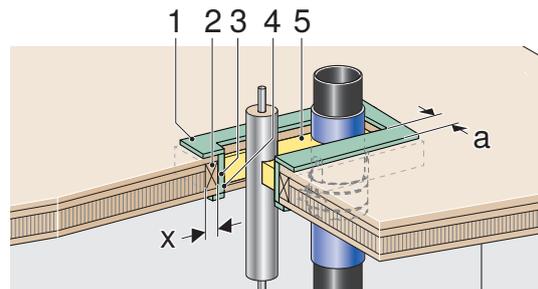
Ausführung des Deckendurchbruchs mit Kragen bei Bauteilen mit brennbaren Oberflächen
